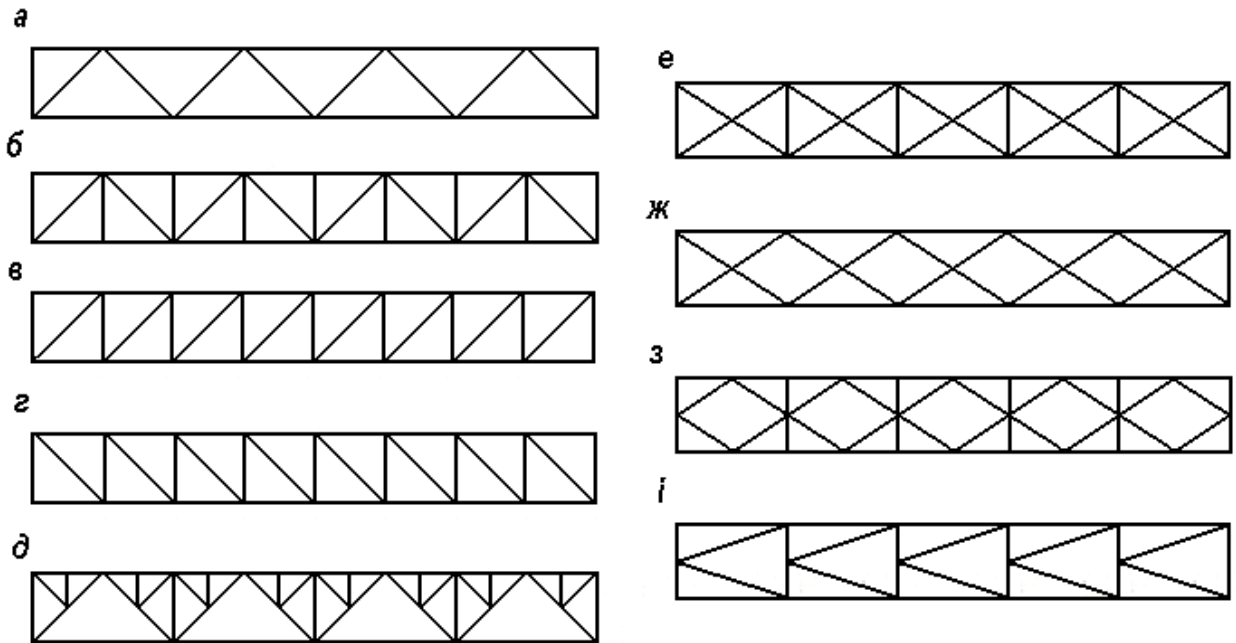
Схеми решіток ферм: а – трикутна; б – трикутна зі стійками; в, г – розкісна; д – шпренгельна; е – хрестова; ж – перехресна; з – ромбічна; і – напіврозкісна
